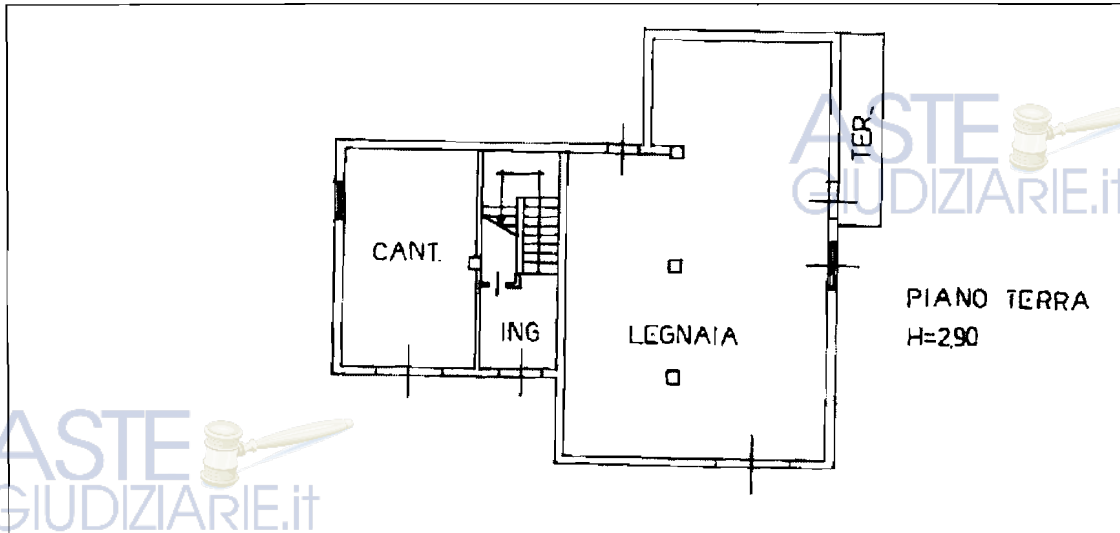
Stralcio Planimetria catastale Dich. Prot. 201280 del 5/6/2002
